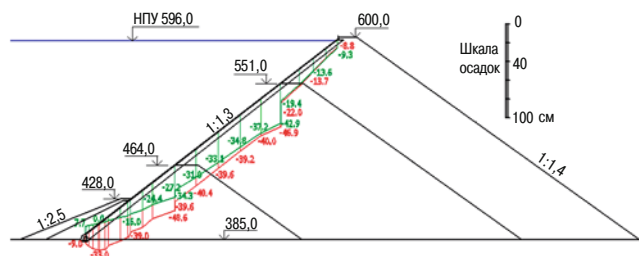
Вертикальные перемещения железобетонного экрана, см, для вариантов 1 и 2:
